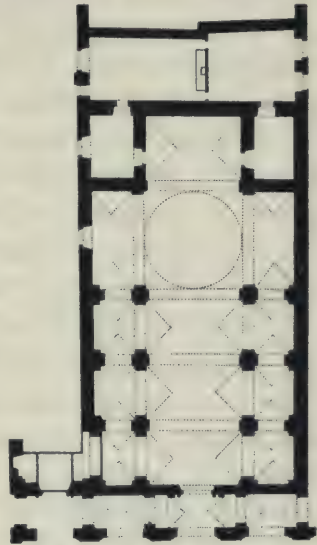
Orduña. Santa Maria Antigua. Grundriß.
